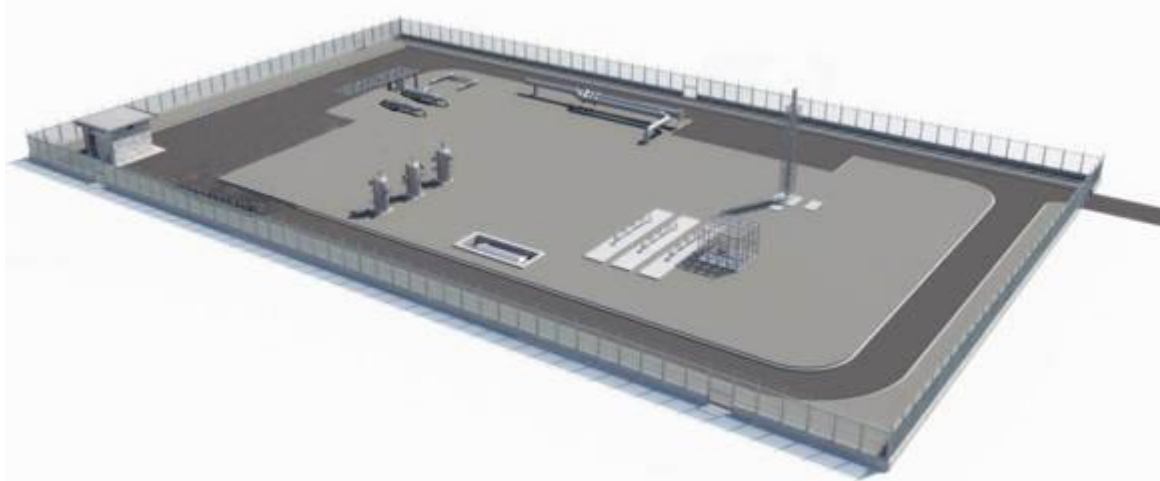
c: Modello Planovolumetrico dell’Impianto No. 16
